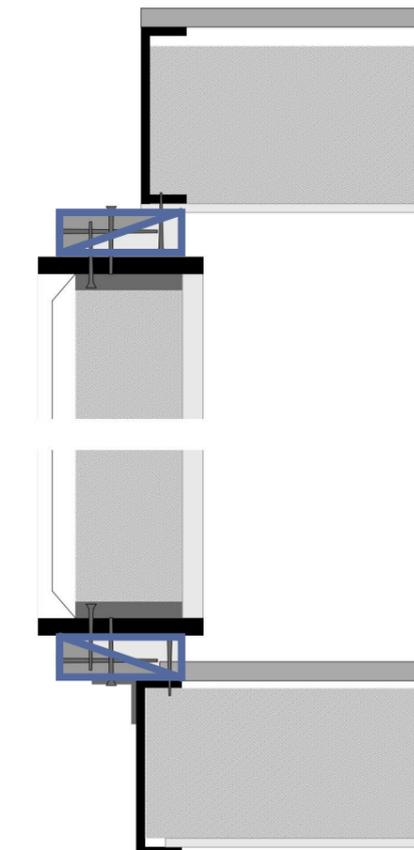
Detalle de fijación superior e inferior mediante cuñas. Fuente: Autoría propia.
